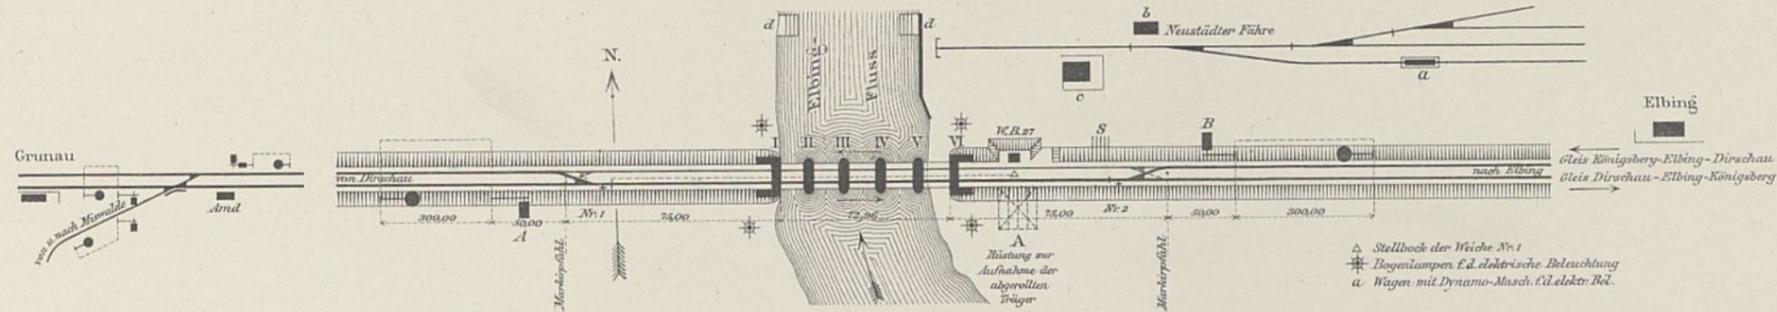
Lageplan der Baustelle und der Strecke zwischen den Stationen Grunau und Elbing.
